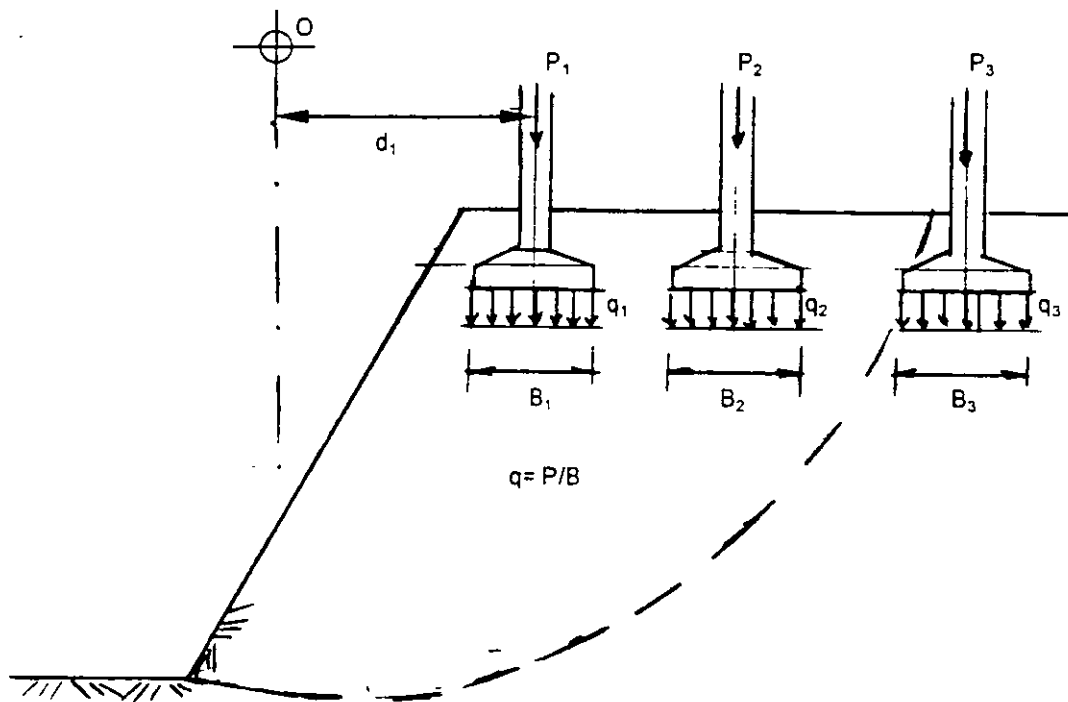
Sobrecarga por zapatas aisladas o continuas
